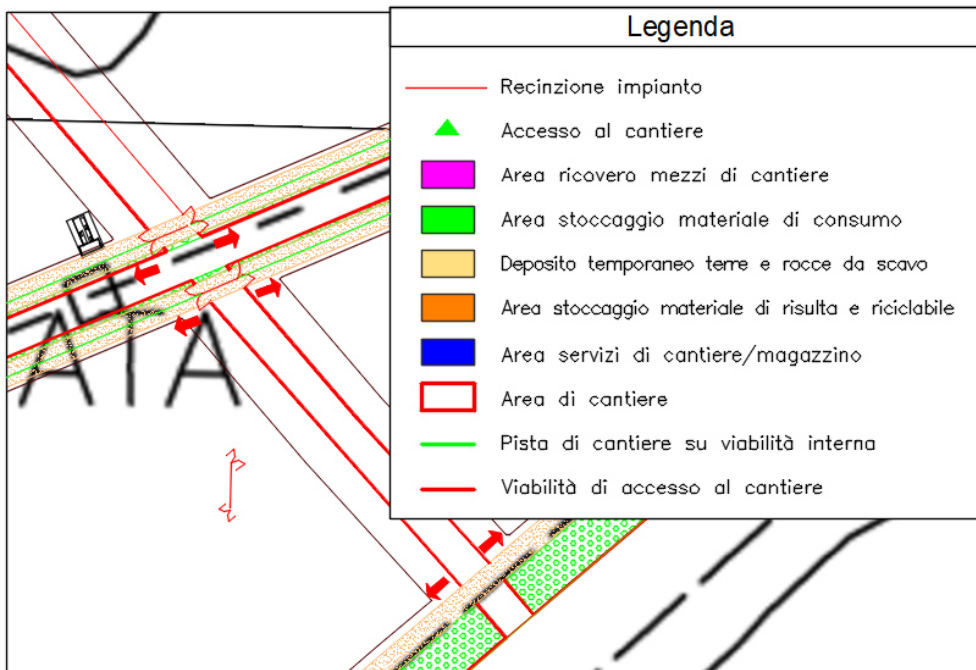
| Particolare accessi 8, 9 10 11 area di cantiere 1
